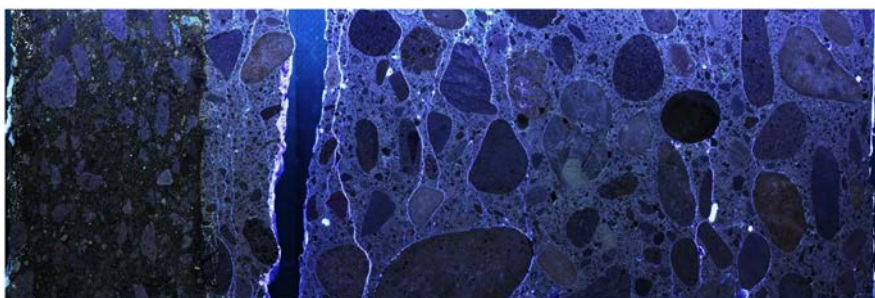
事例 1, コアのひび割れ状況 (下は蛍光エポキシ樹脂によるひび割れ観察)
